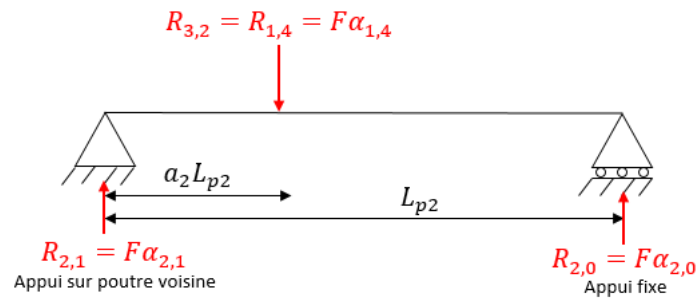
Schéma statique d'une poutre type 2 du plancher rectangulaire avec 1 sens de portée
